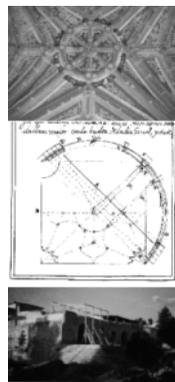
Áreas en planta suponiendo una piedra clave
